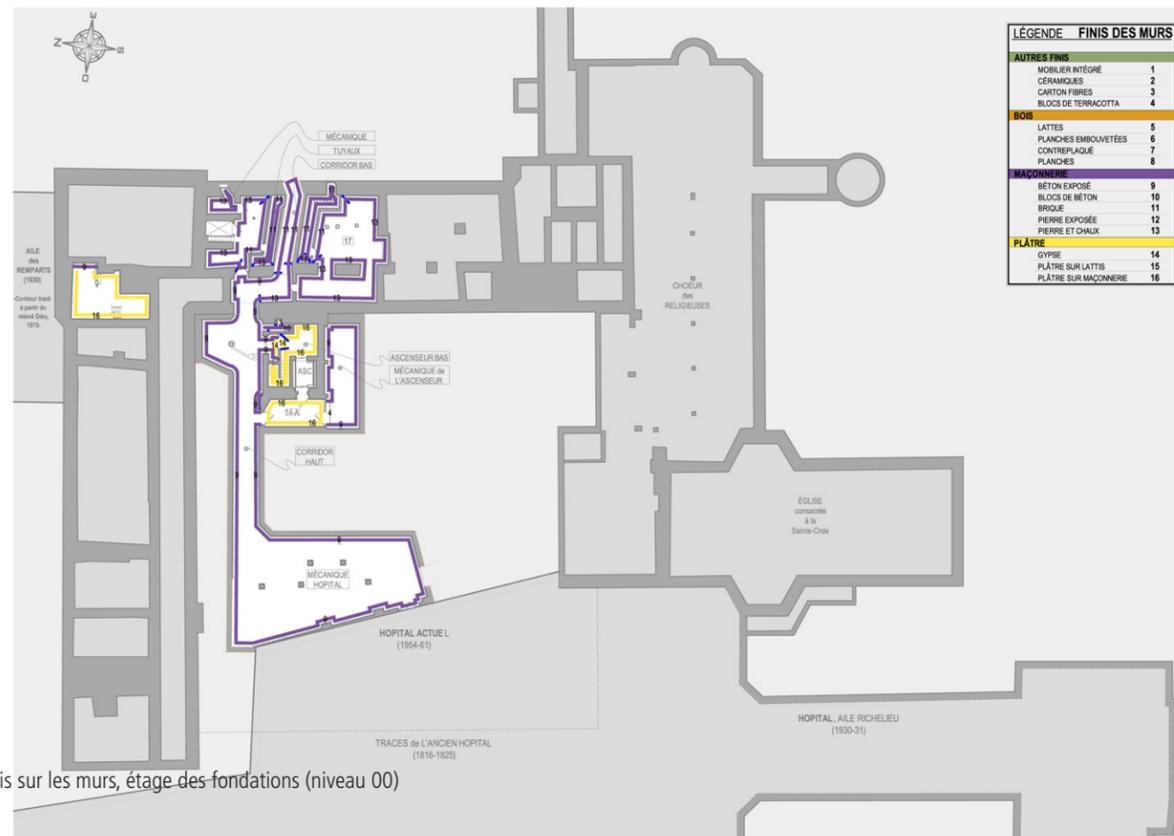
Plan des finis sur les murs, étage des fondations (niveau 00)
